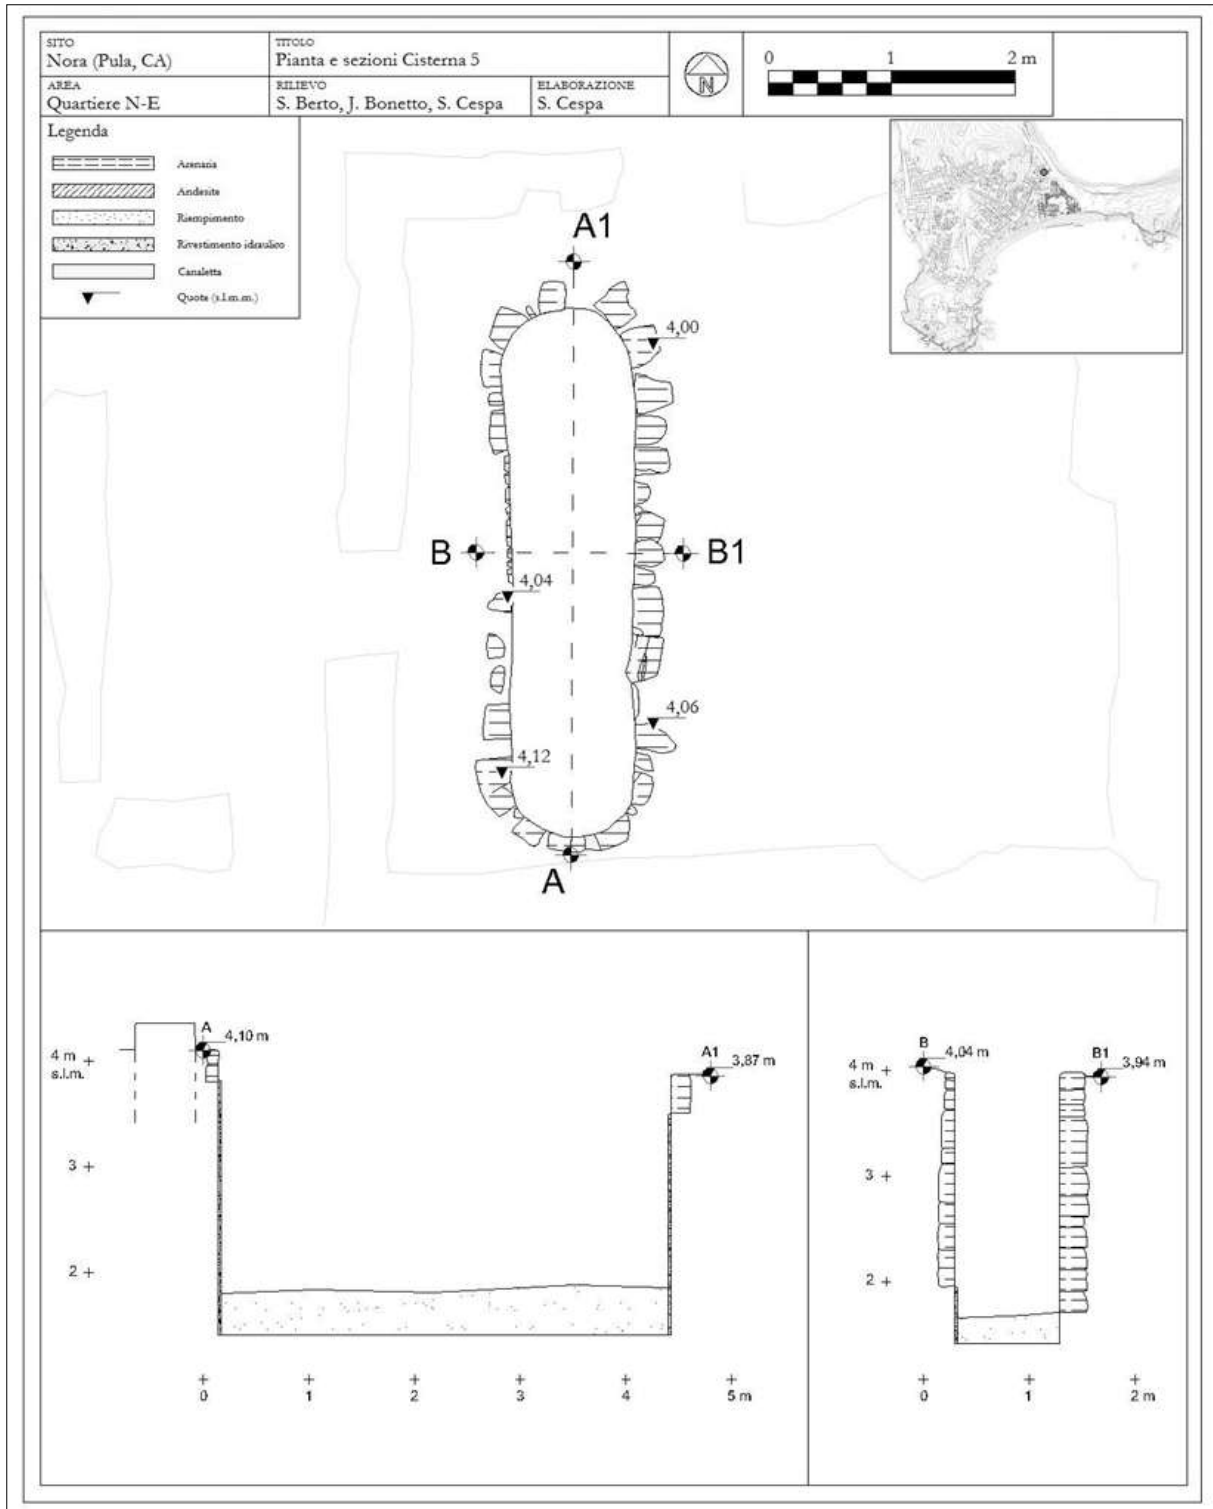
Pianta e sezioni della cisterna 5 (elaborazione dell'autore).
